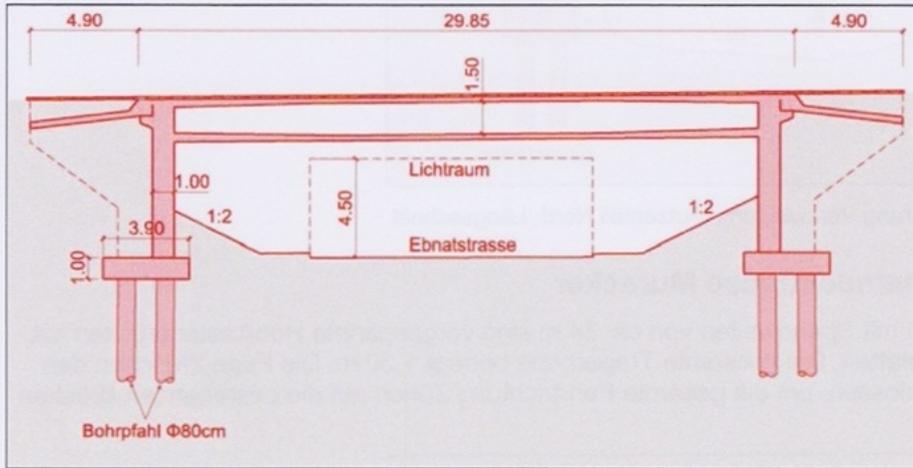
Unterführung Gemeindestrasse Muracker, Längsschnitt der neuen Brücken
